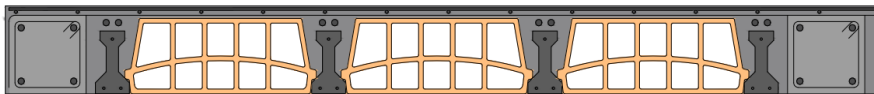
Detalle zuncho y forjado. 2024. Fuente: Propia
